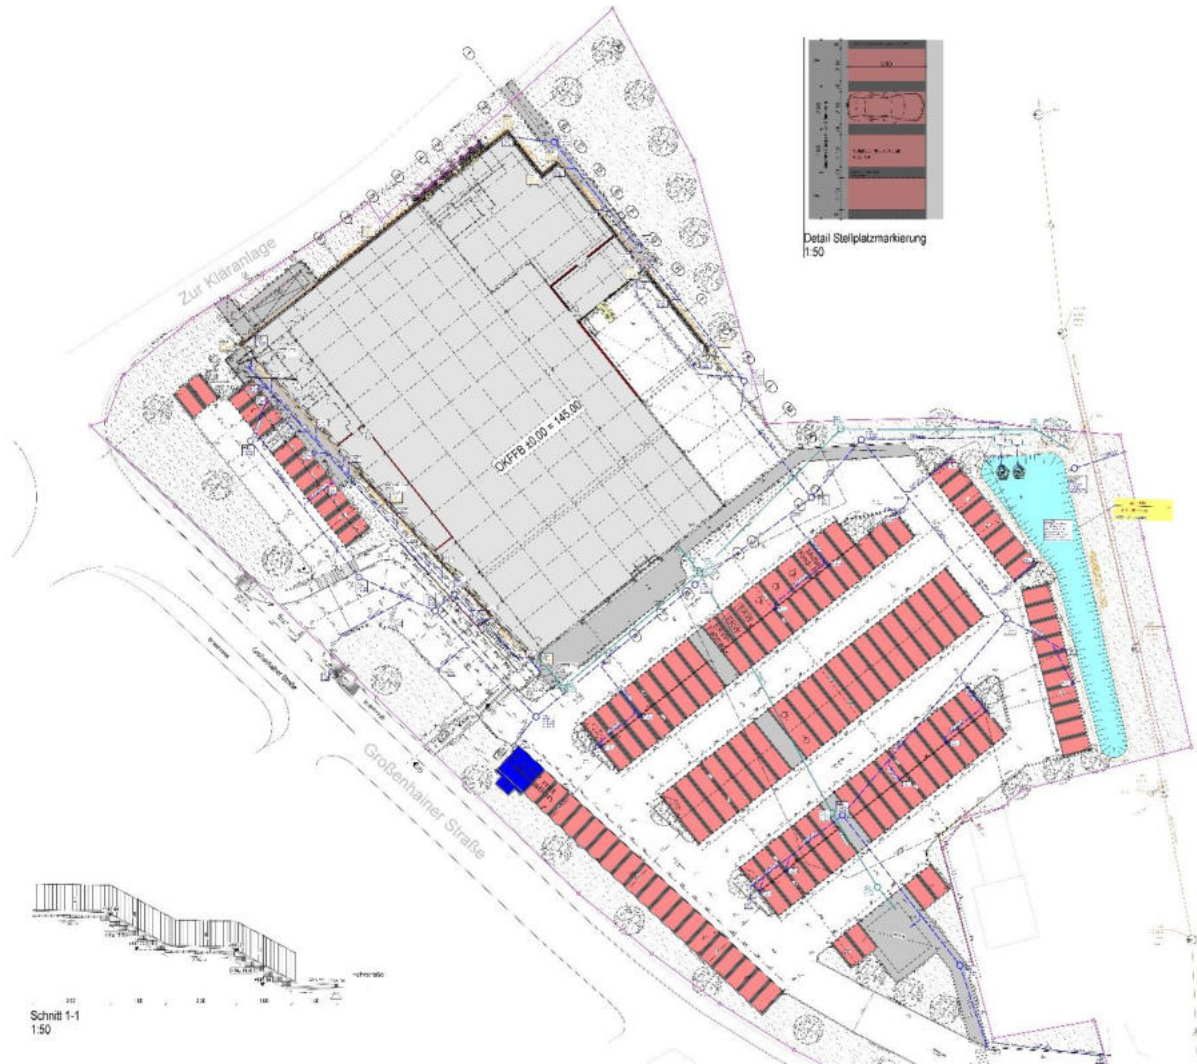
Werkplan Außenanlage gesamt (Ausschnitt), Stand 08.01.2024
